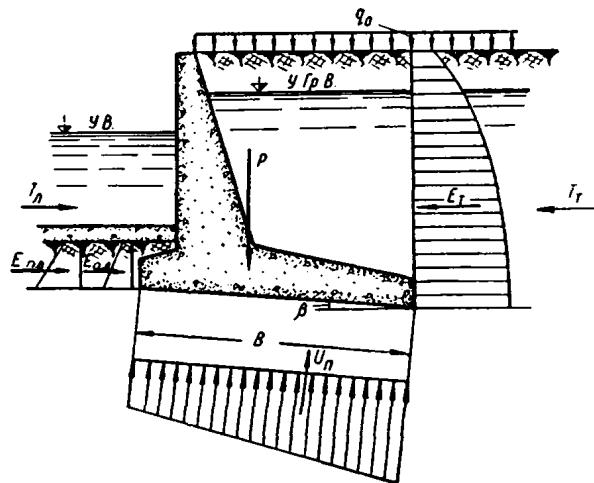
К расчету устойчивости подпорных стен на нескальных основаниях при наклоне плоскости скольжения в сторону грунта
